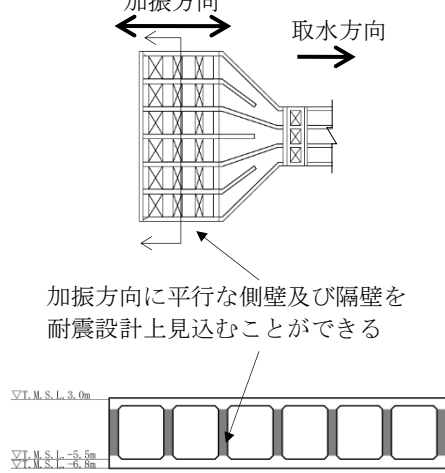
スクリーン室（6号機設備）の平面配置図（平面図）
